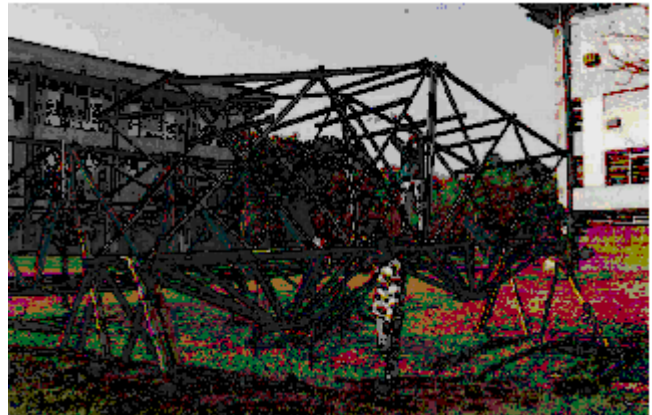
Modelo B - Sistema de viga atensorada con columnas flotantes espaciales.
